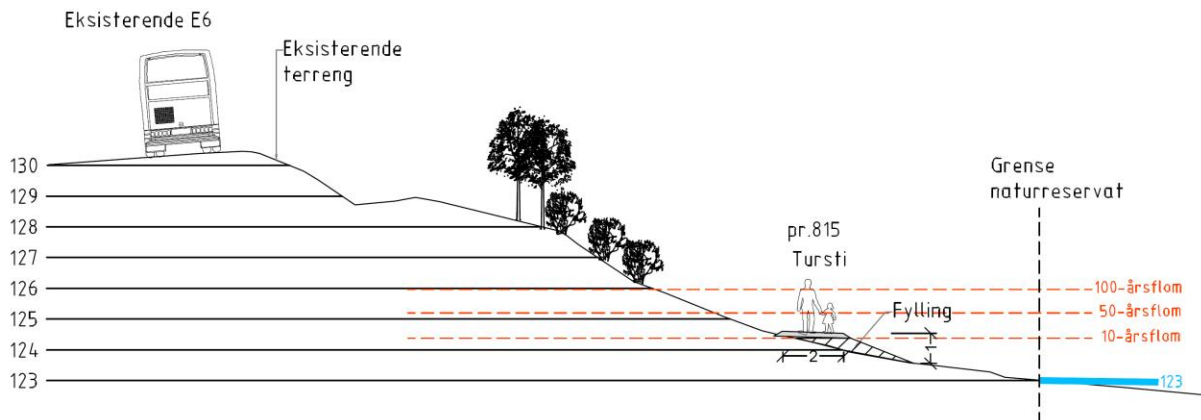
Tursti fra Riselandet til Brettengsvika, strekning 4-8.
